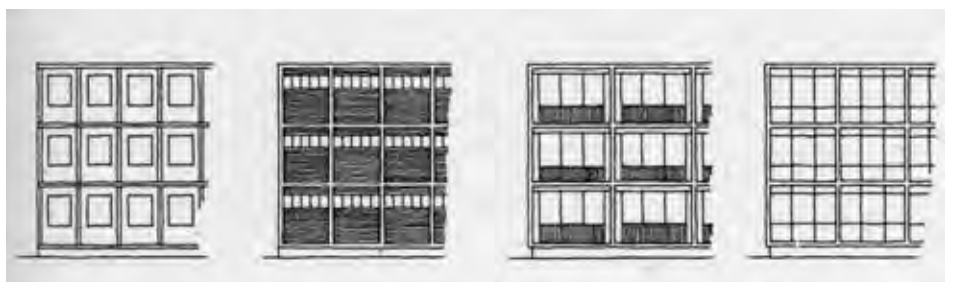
Beispiele Skelettbau mit Vorhangfassade (teilweise mit in der Fassade sichtbaren Deckenplatten)
